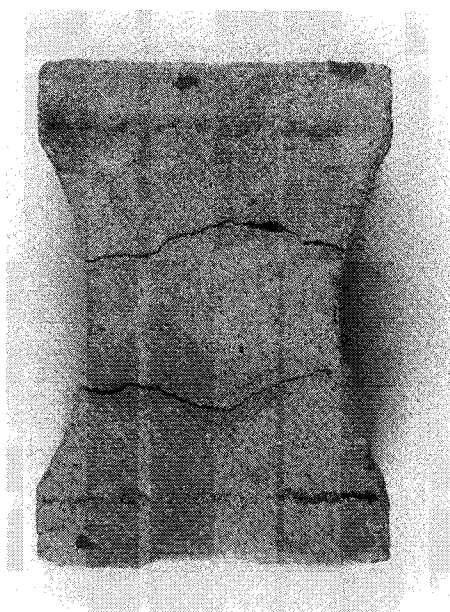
Fisuración múltiple en un ensayo de tracción directa.
